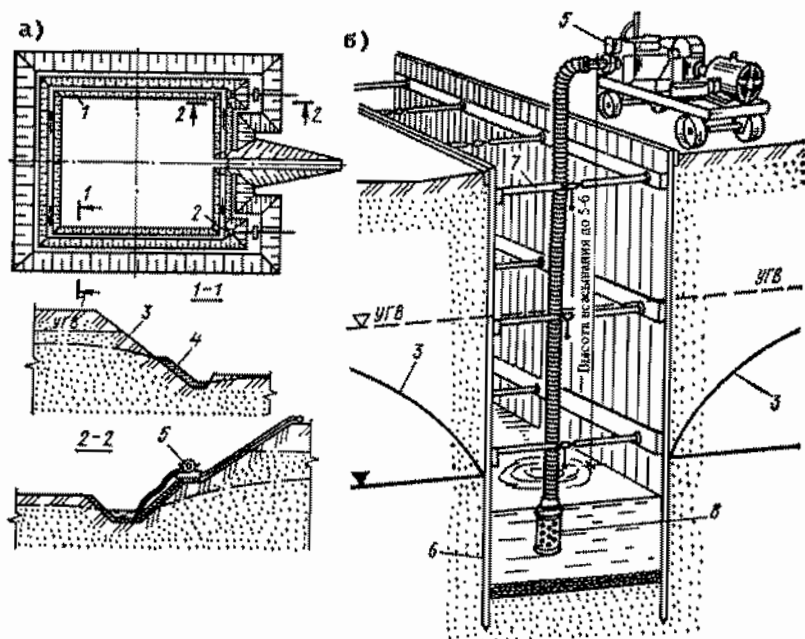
Открытый водоотлив из котлована (а) и траншей (б): 1 - дренажная канава; 2 - приямок (зумпф); 3 - пониженный уровень грунтовых вод; 4 - дренажная пригрузка; 5 - насос; 6 - шпунтовое крепление; 7 - инвентарные распорки; 8 - всасывающий рукав с сеткой (фильтром)
